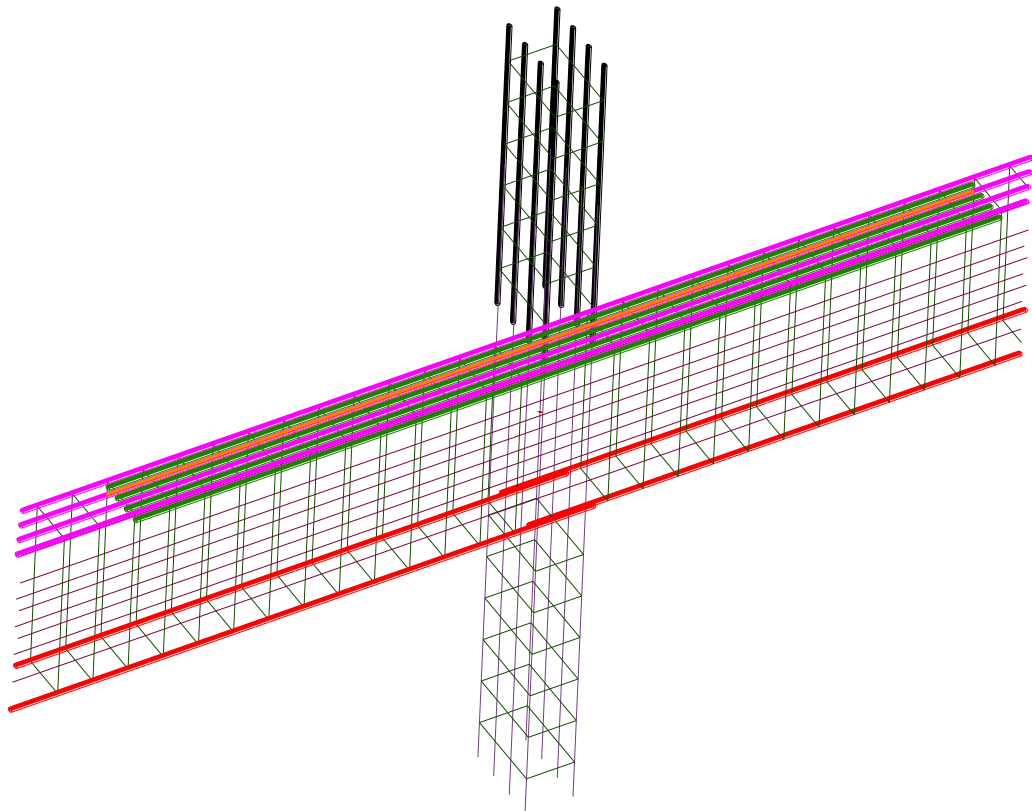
Trecho da armadura da viga no pilar interno.
